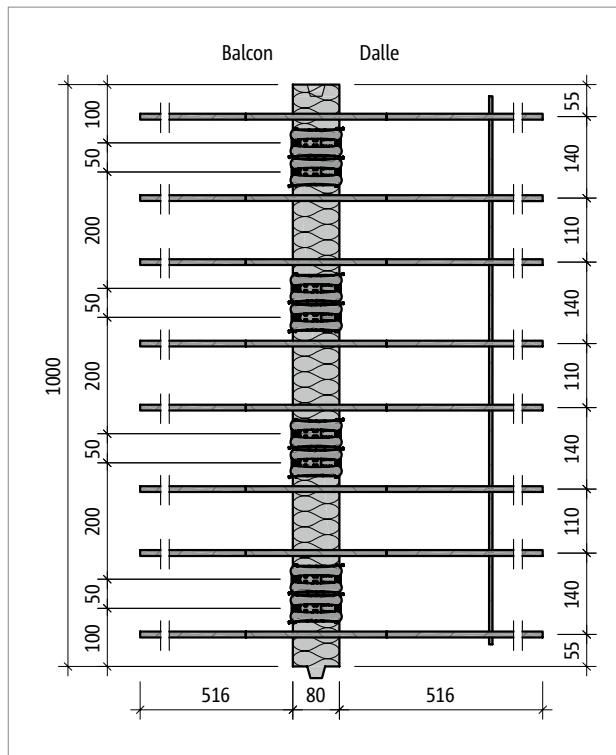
Schöck Isokorb® T Type Q-E-V5 : Plan de base du produit
